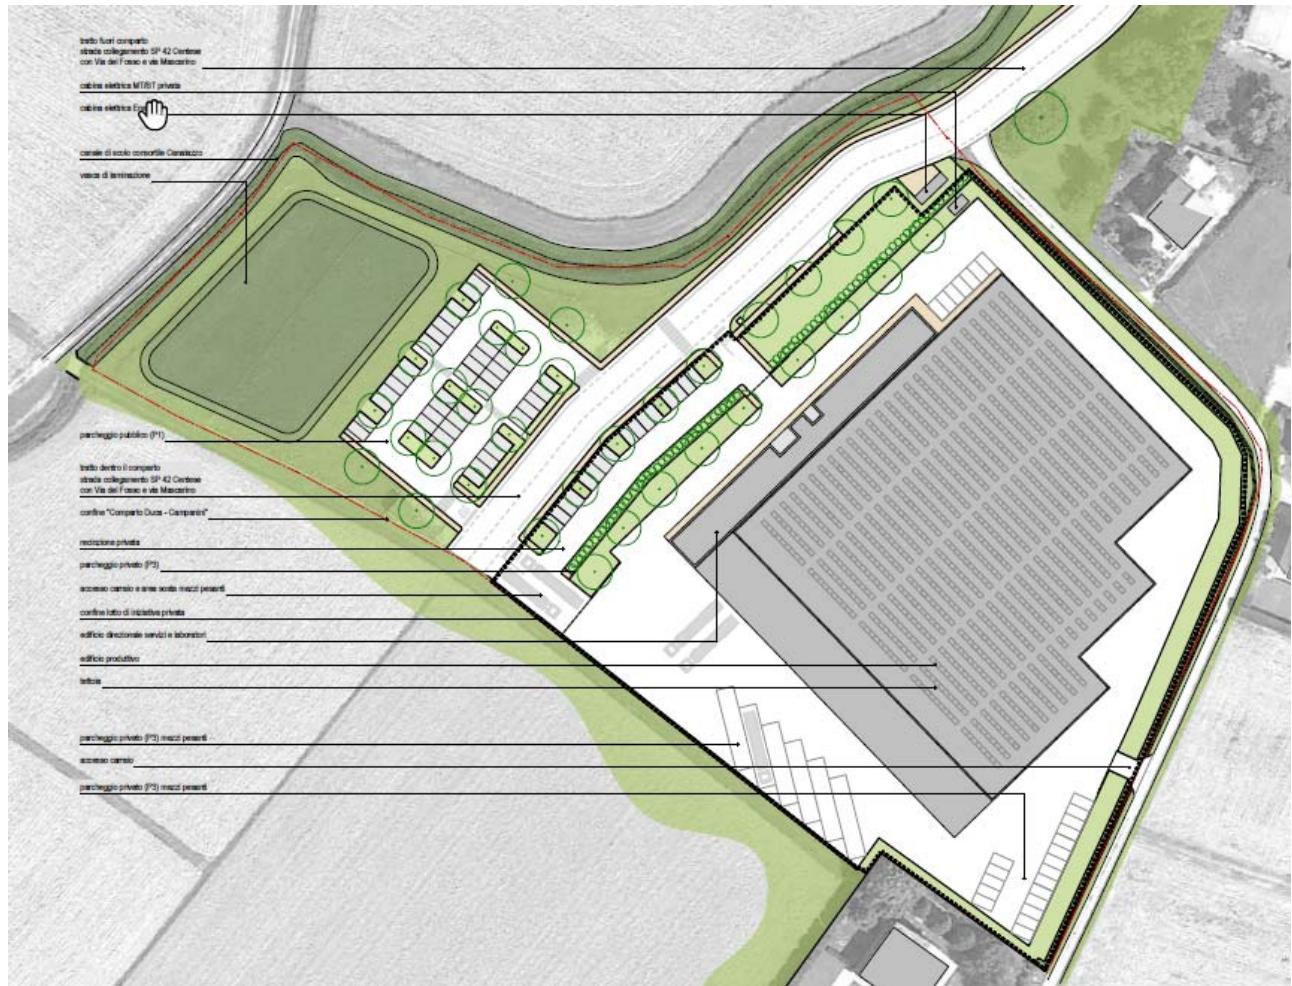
Planimetria d'insieme (vedi tavola U004: planimetria generale).
